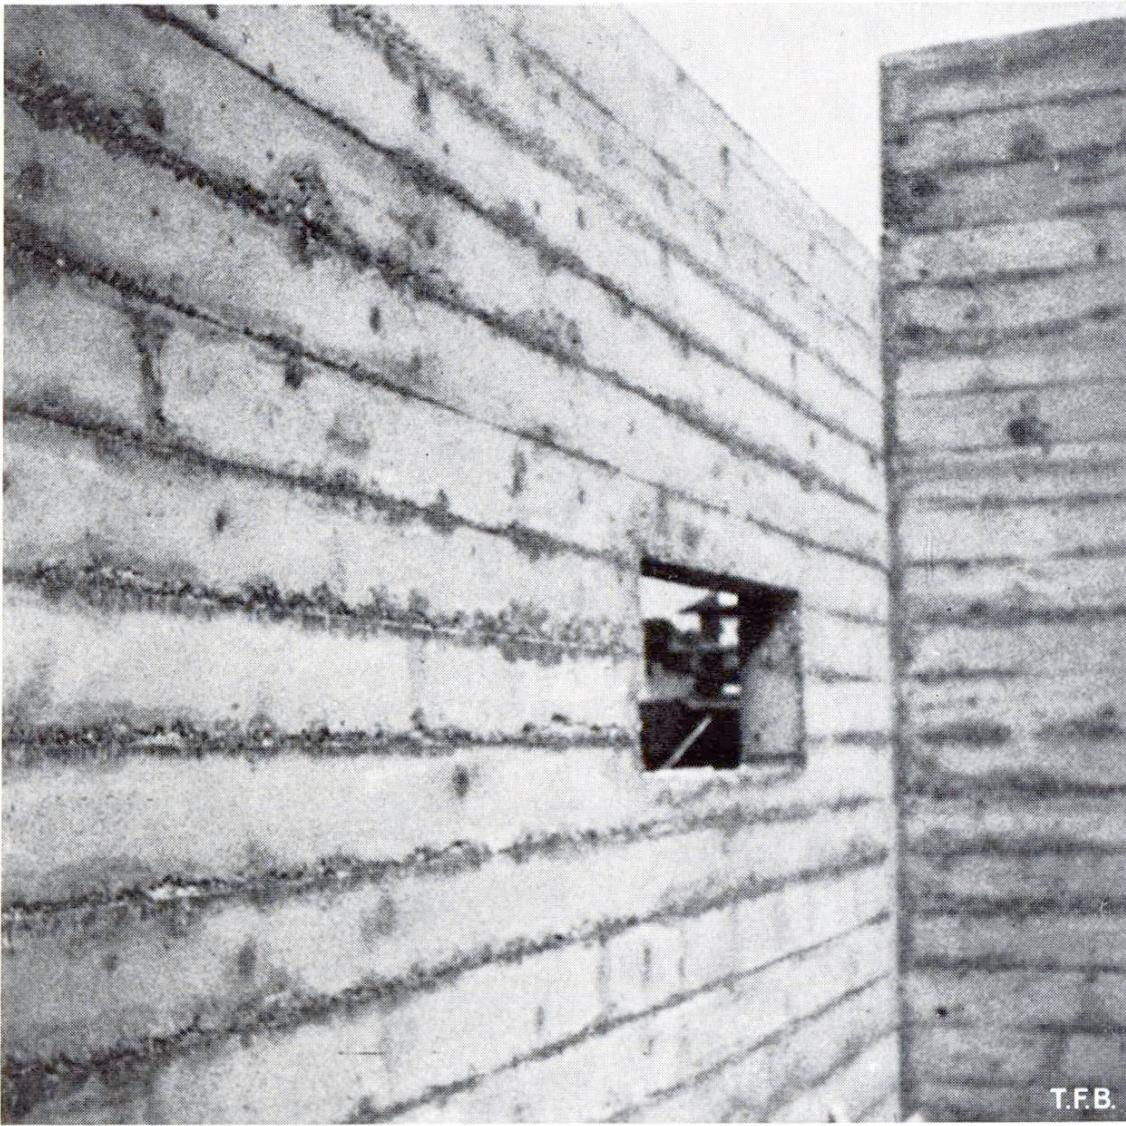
Grave manque d'étanchéité entre les planches d'un coffrage. L'amaigrissement et le manque de compacité du béton mettent ici l'armature en danger.
